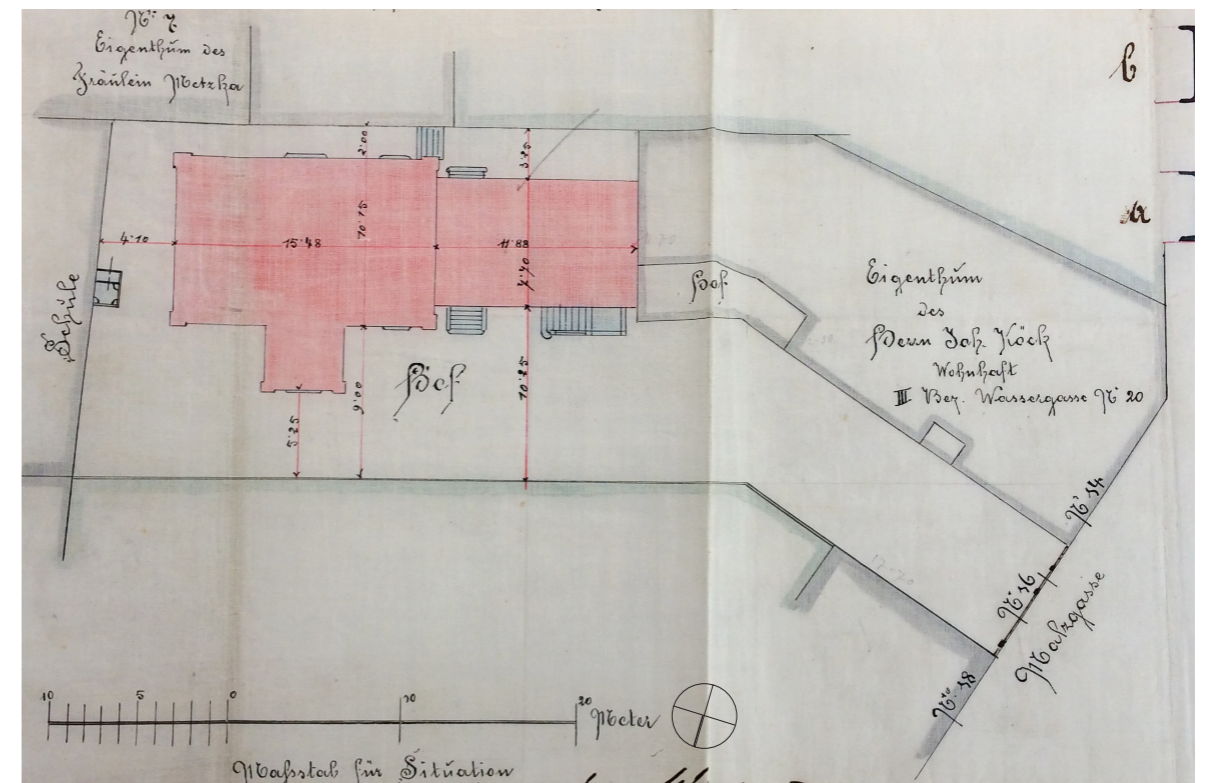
Lageplan Einreichung (1884) [ma37]
